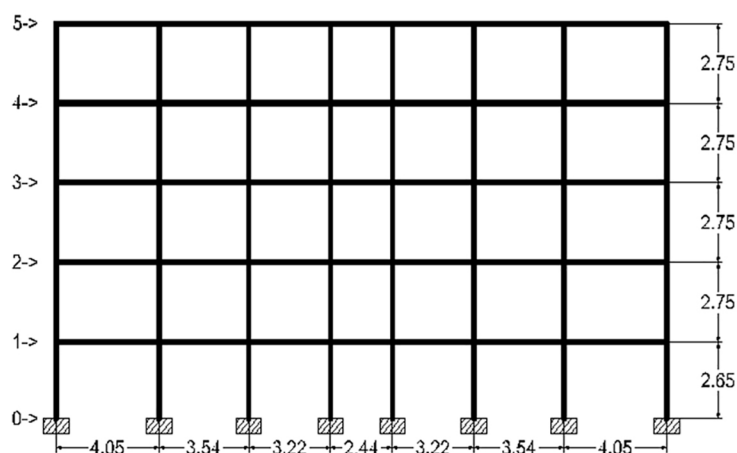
Vista en elevación del edificio en estudio (dimensiones en metros). Las dimensiones y refuerzo de los elementos estructurales (vigas y columnas) están detallados en el CUADRO I.
